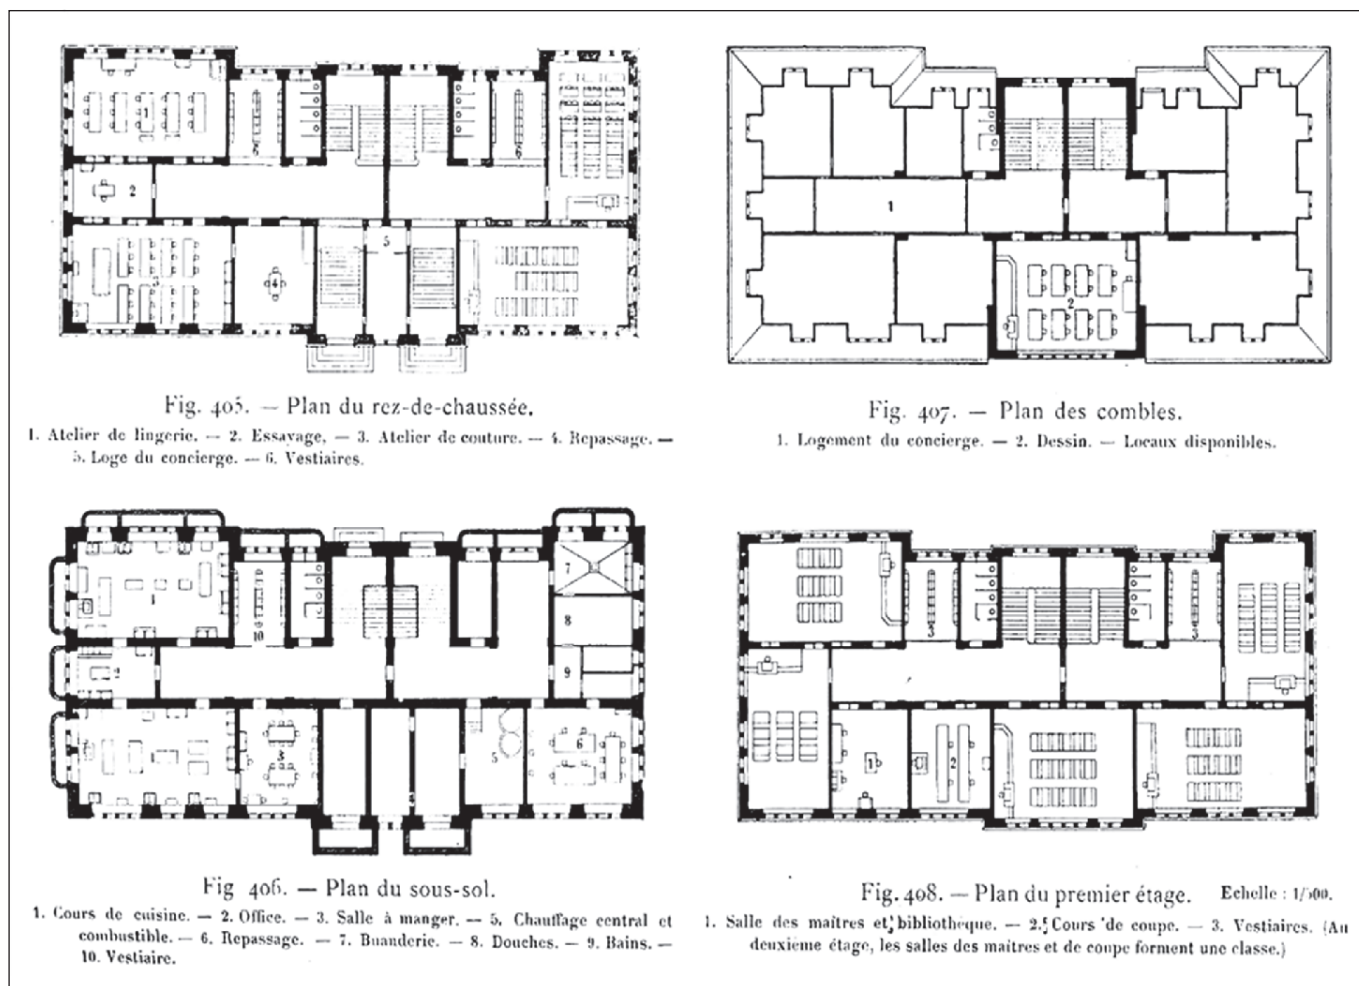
Plans du bâtiment réalisé, publiés en 1907 par Henry Baudin dans son ouvrage sur les constructions scolaires suisses
